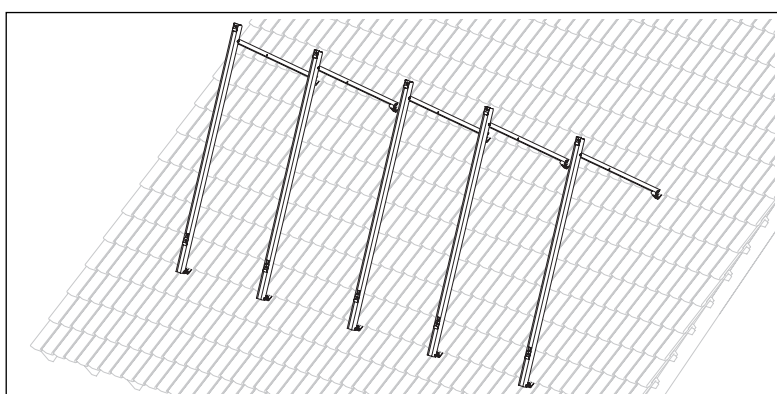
Konstrukci vzadu upevněte na závrtný šroub
